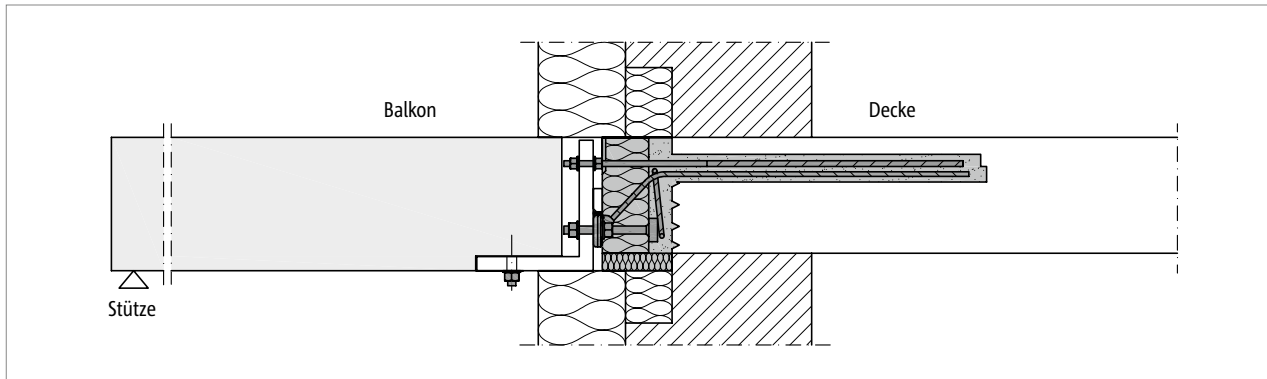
Schöck Isokorb® RT Typ SK: Anschluss eines Fertigteile balkons an eine Bestandsdecke, gestützte Konstruktion
